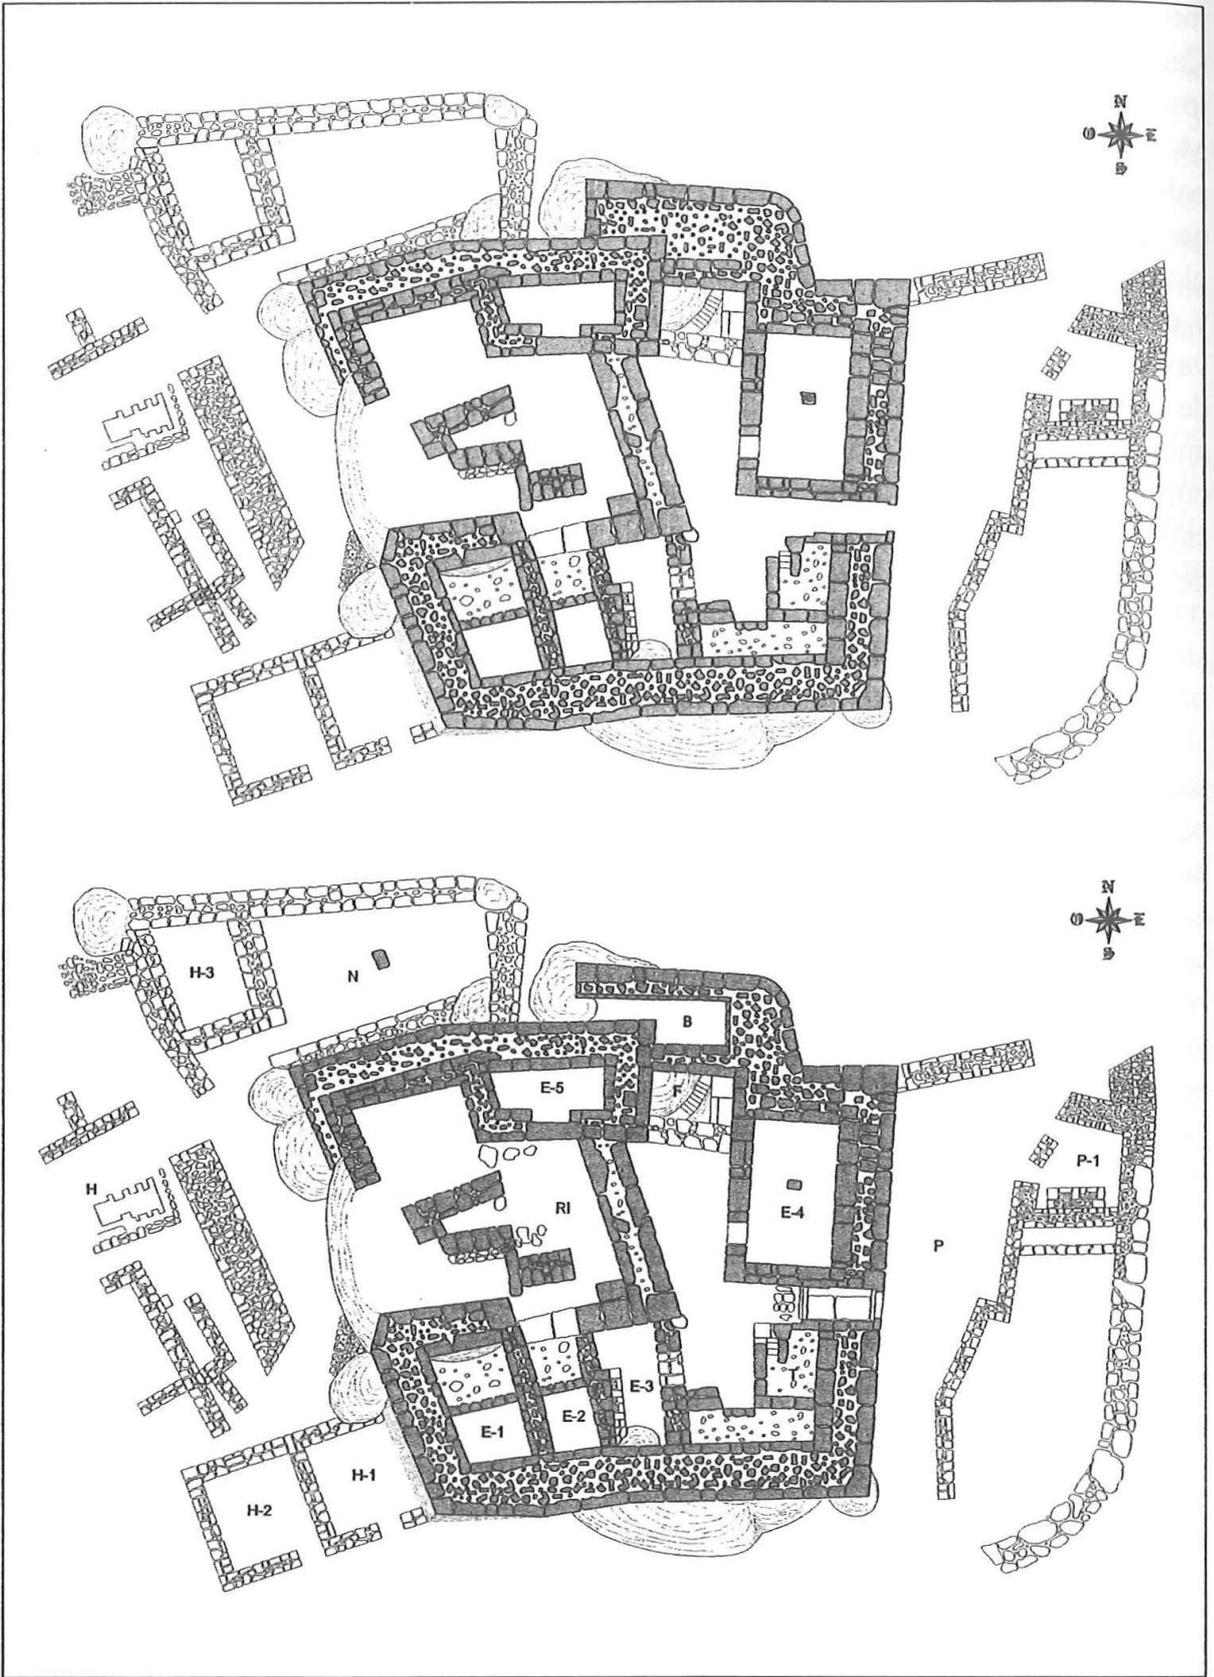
Recinto-torre de Hijovejo. Fase III y Restauración.
